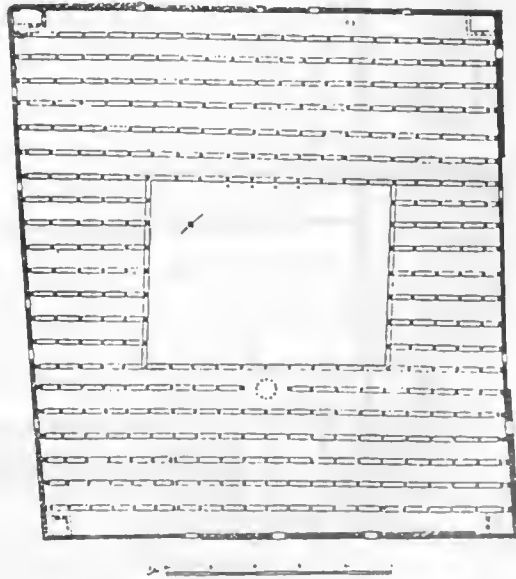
المسقط الأفقي لجامع السيدة بنت أحمد عن
